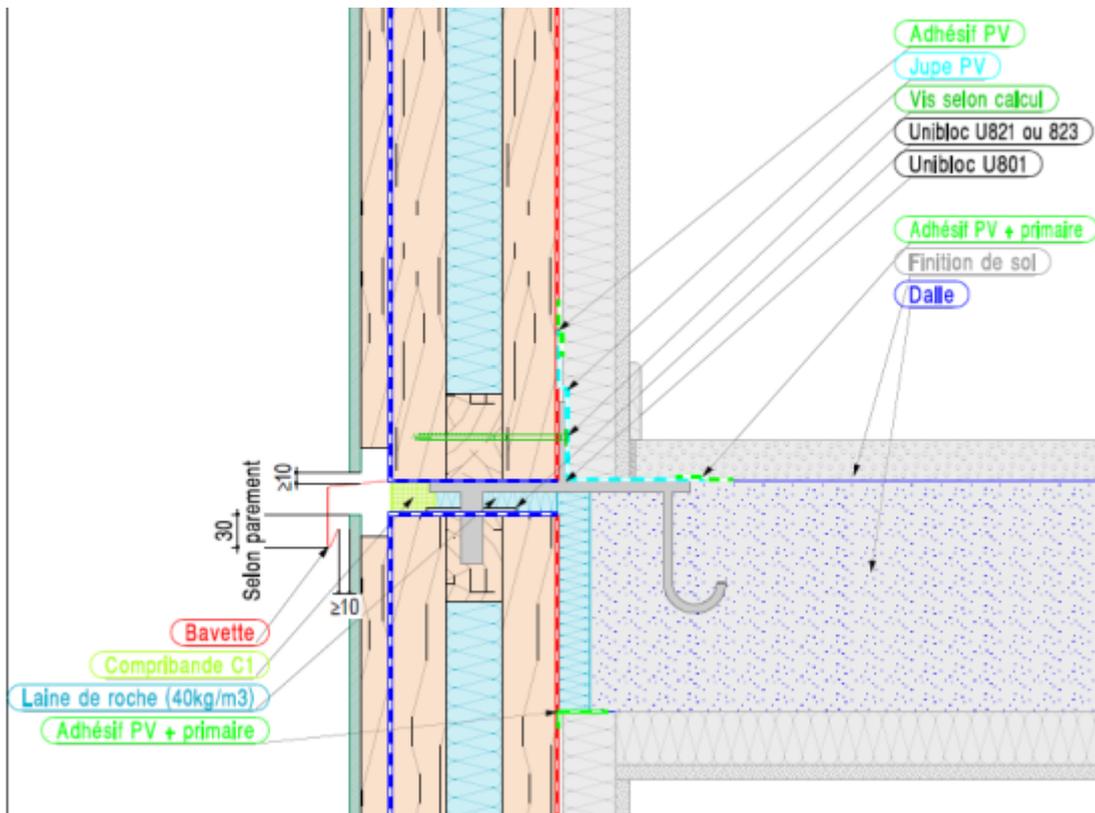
Raccord de panneaux sur dalle béton, fixation par solution d'ancrage UNIBLOC®CYCLE, avec parement extérieur ventilé / coupe verticale
